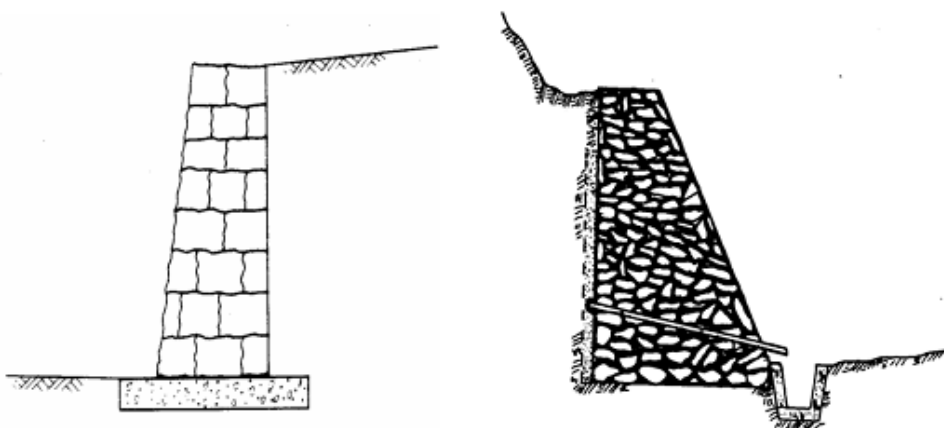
Muros em Alvenaria de Pedra ou Enrocamento [58]
